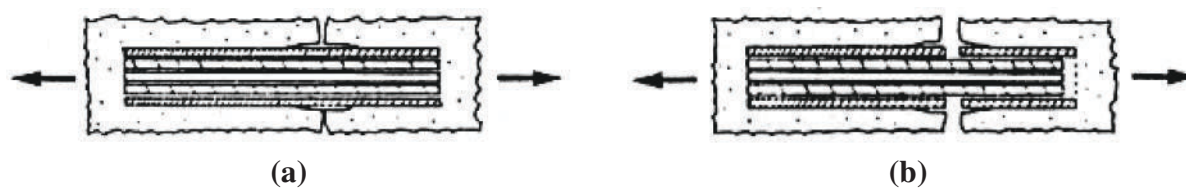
Início das primeiras fissuras (a) e arrancamento das fibras (b)
